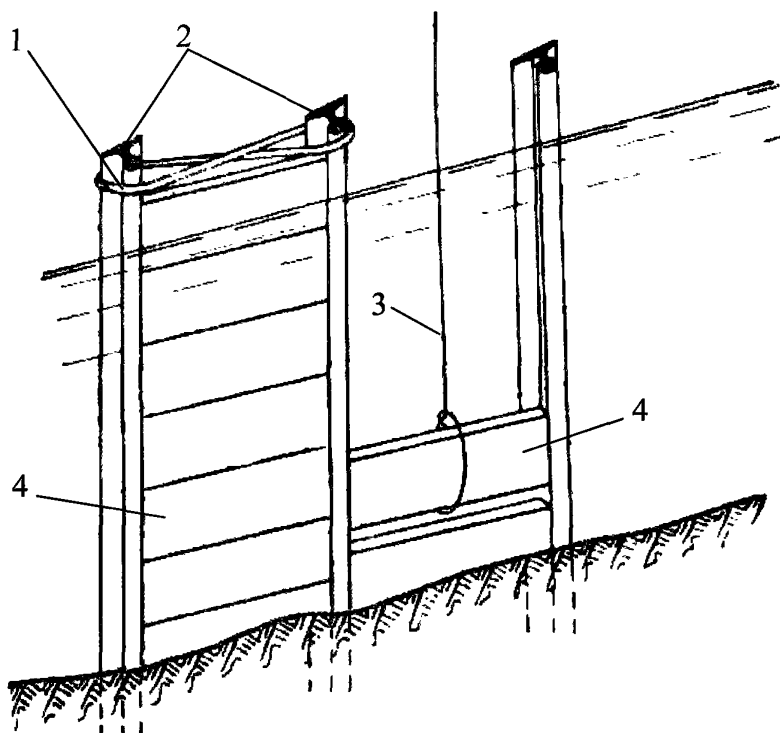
Схема возведения опалубки из бетонных плит:
